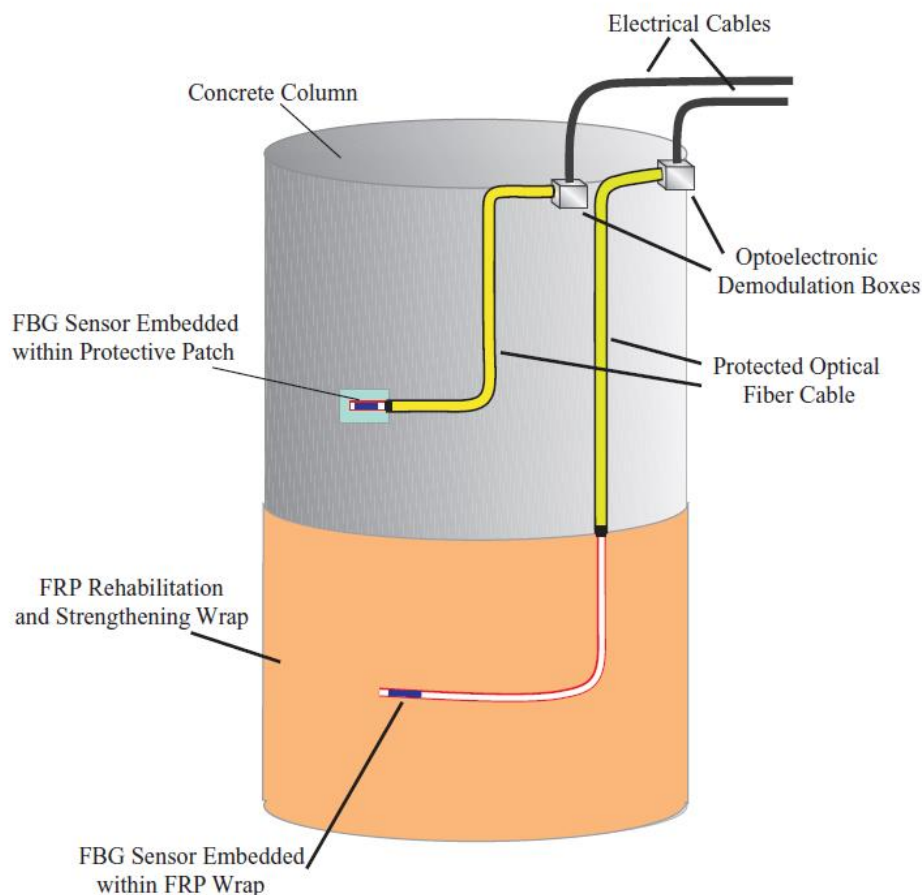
Montaje de fibras sobre estructuras de concreto^[1]
